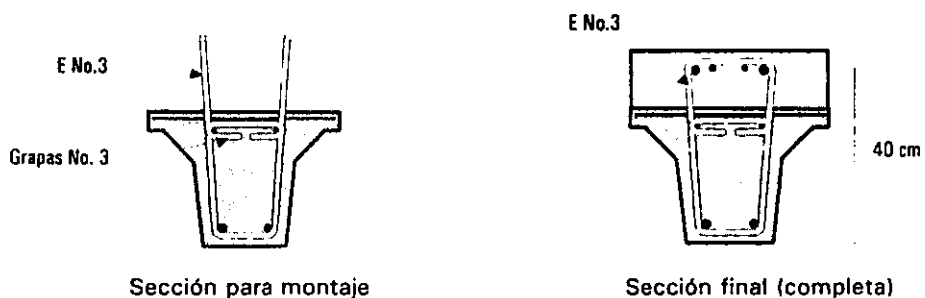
Refuerzo para fuerza cortante en las vigas de rigidez
